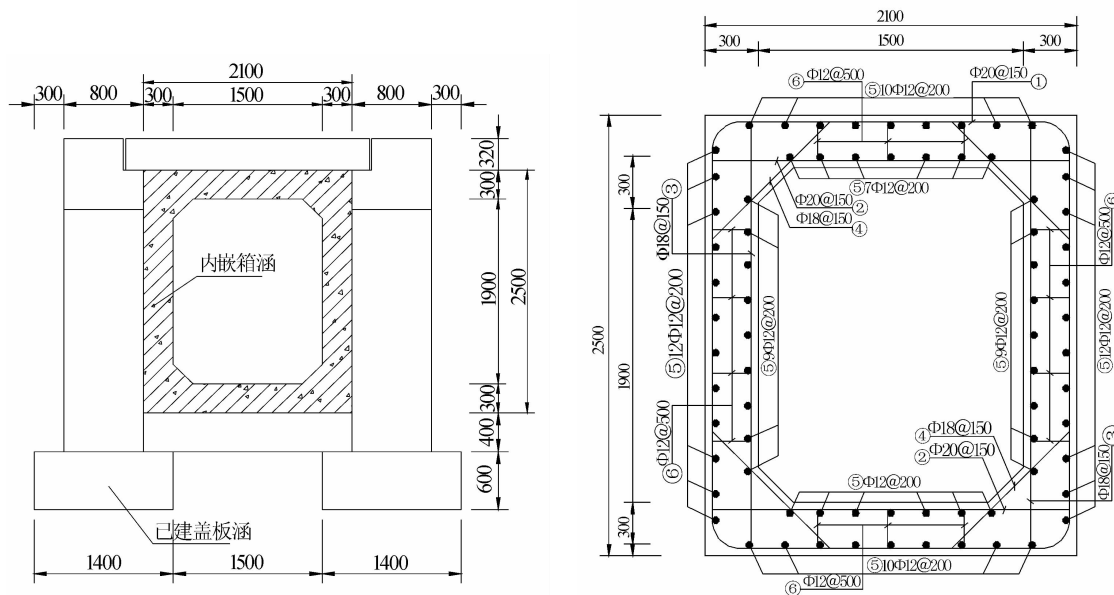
箱涵内嵌加固横断面图和配筋图(单位:mm)
